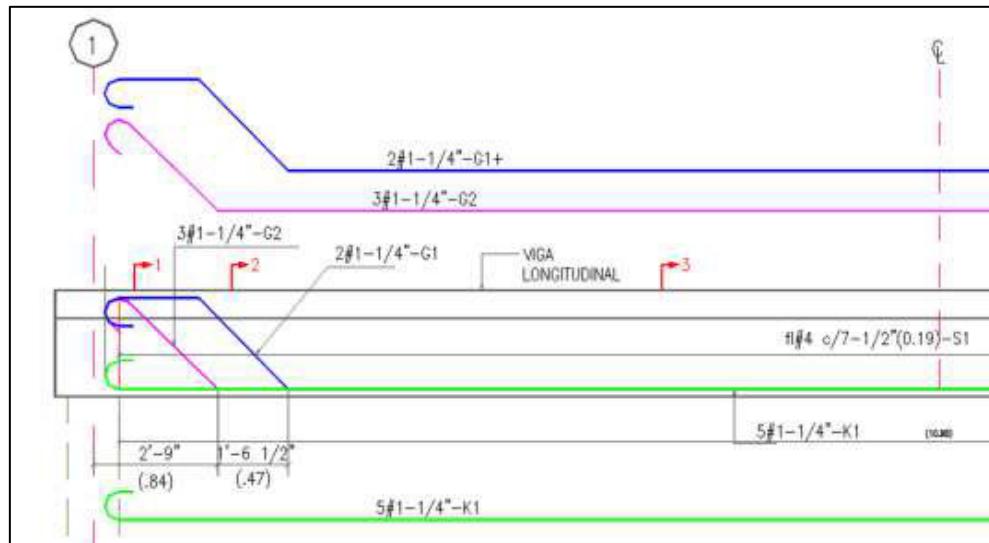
Refuerzo longitudinal viga – VGE – transcripta
